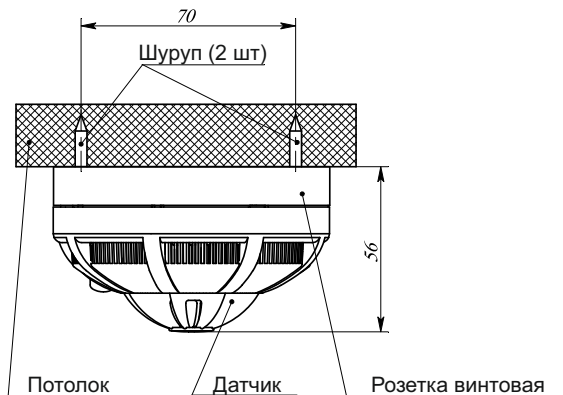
Установка извещателя на потолке (несущая конструкция).
